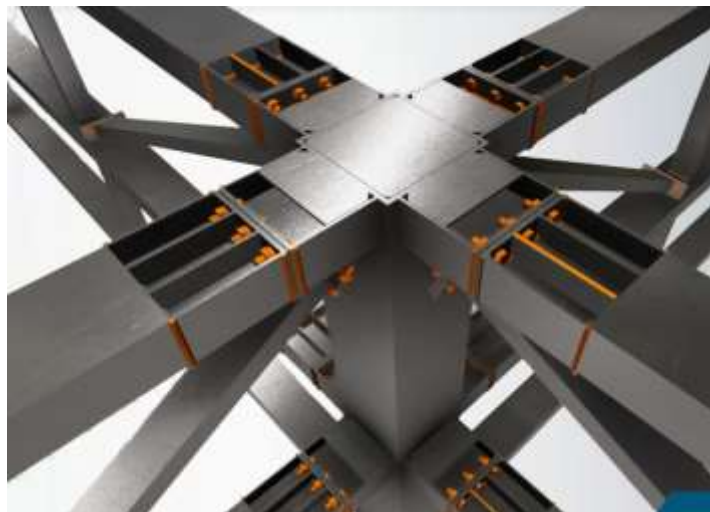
Modelo en Tekla Structures con estructuras metálicas – Puente Nanay
